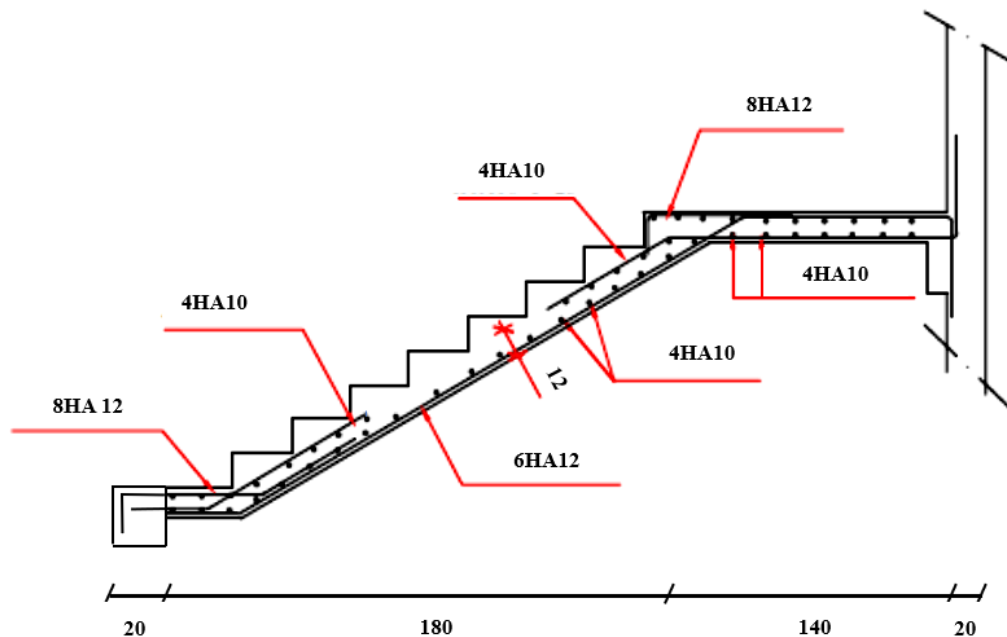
Ferrailage du volée 2 de l'escalier du RDC
